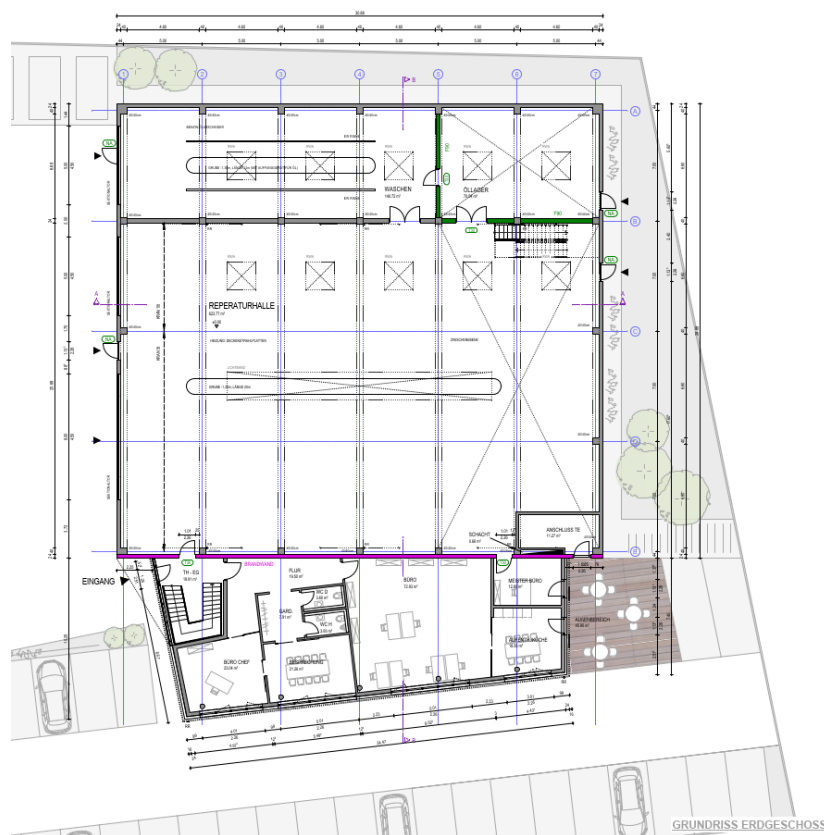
Grundriss EG [Quelle: Architekturbüro Hans Augustin, Nürnberg]
